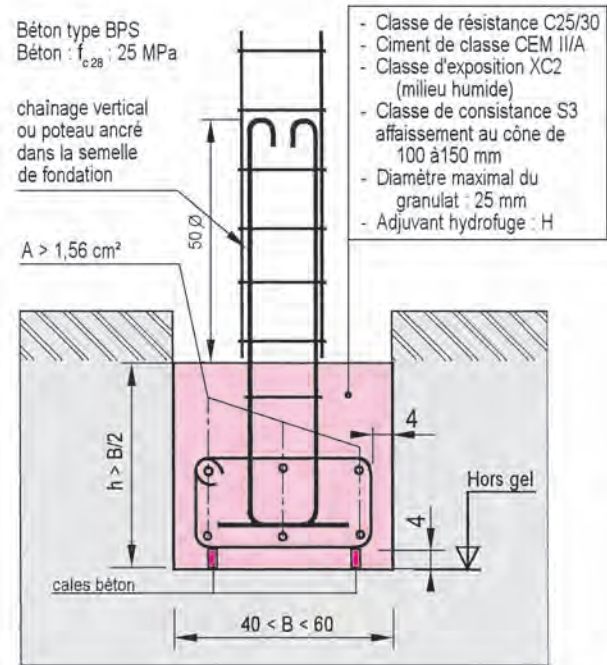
Semelle continue en béton armé coulée pleine fouille
